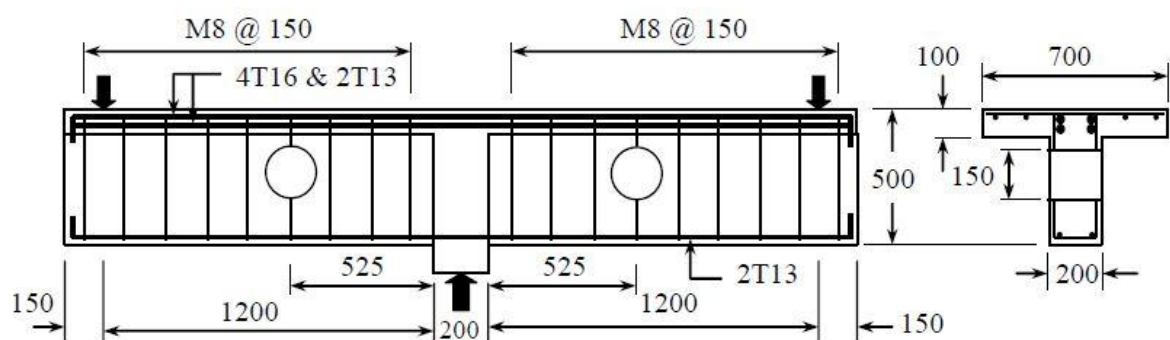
Geometria e armaduras da viga O de Mansur (2006).
